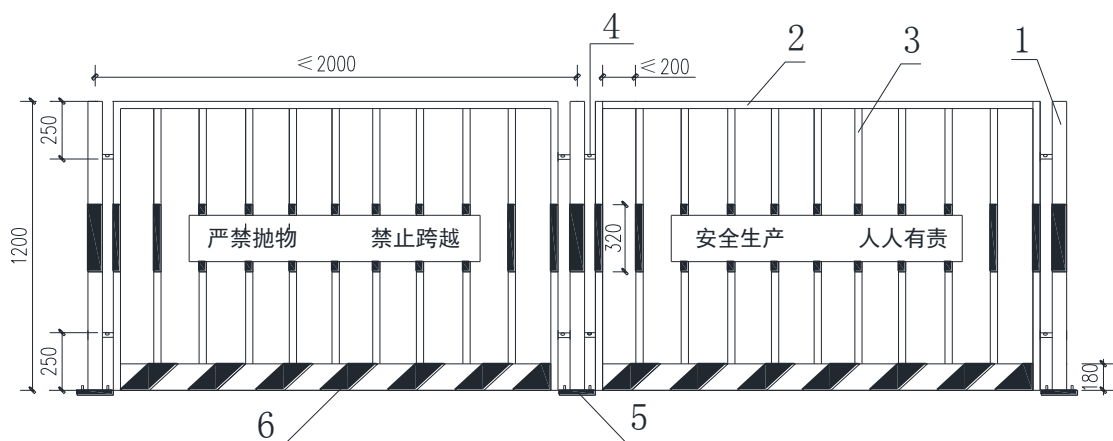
格栅式防护栏示意图 (单位: mm)
